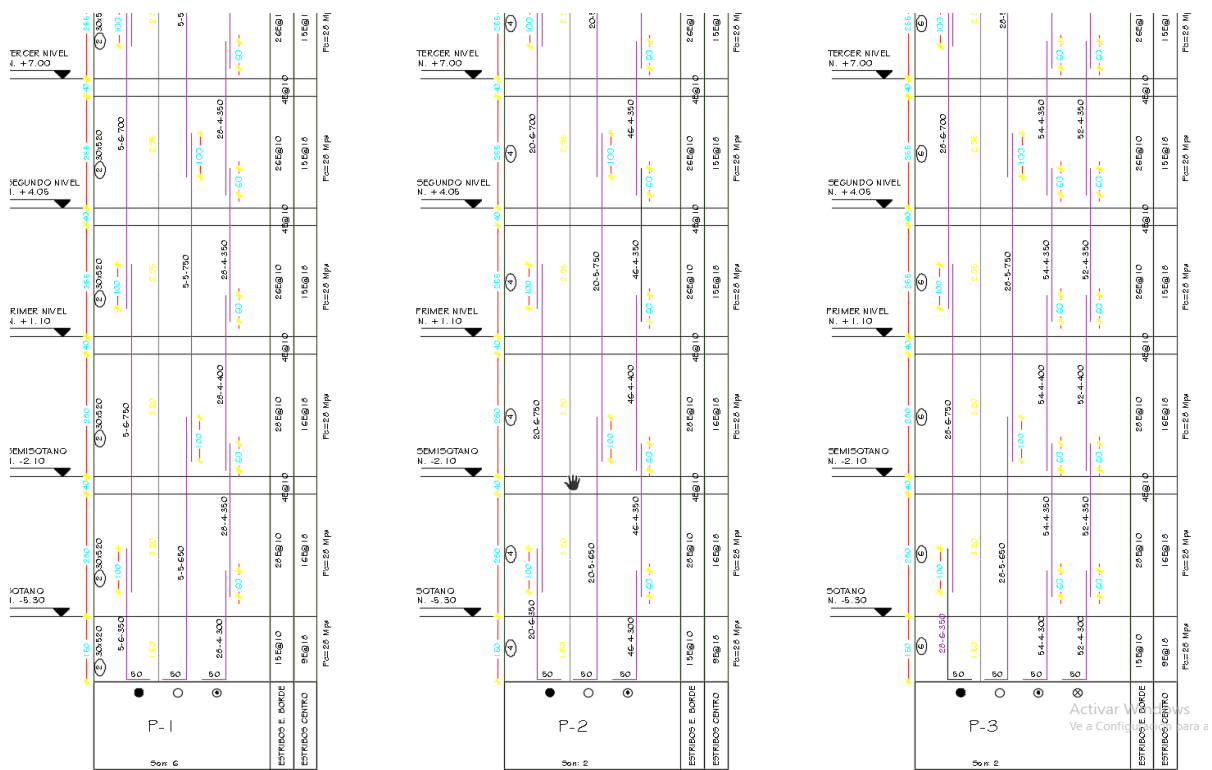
Plano en planta y tipo de pantallas o muros estructurales condominio Marsella.
